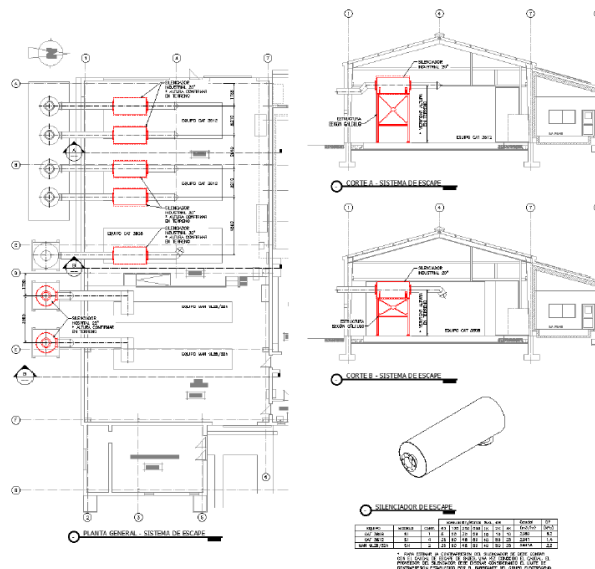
Esquema de Entregable a Nivel de Ingeniería Conceptual.
